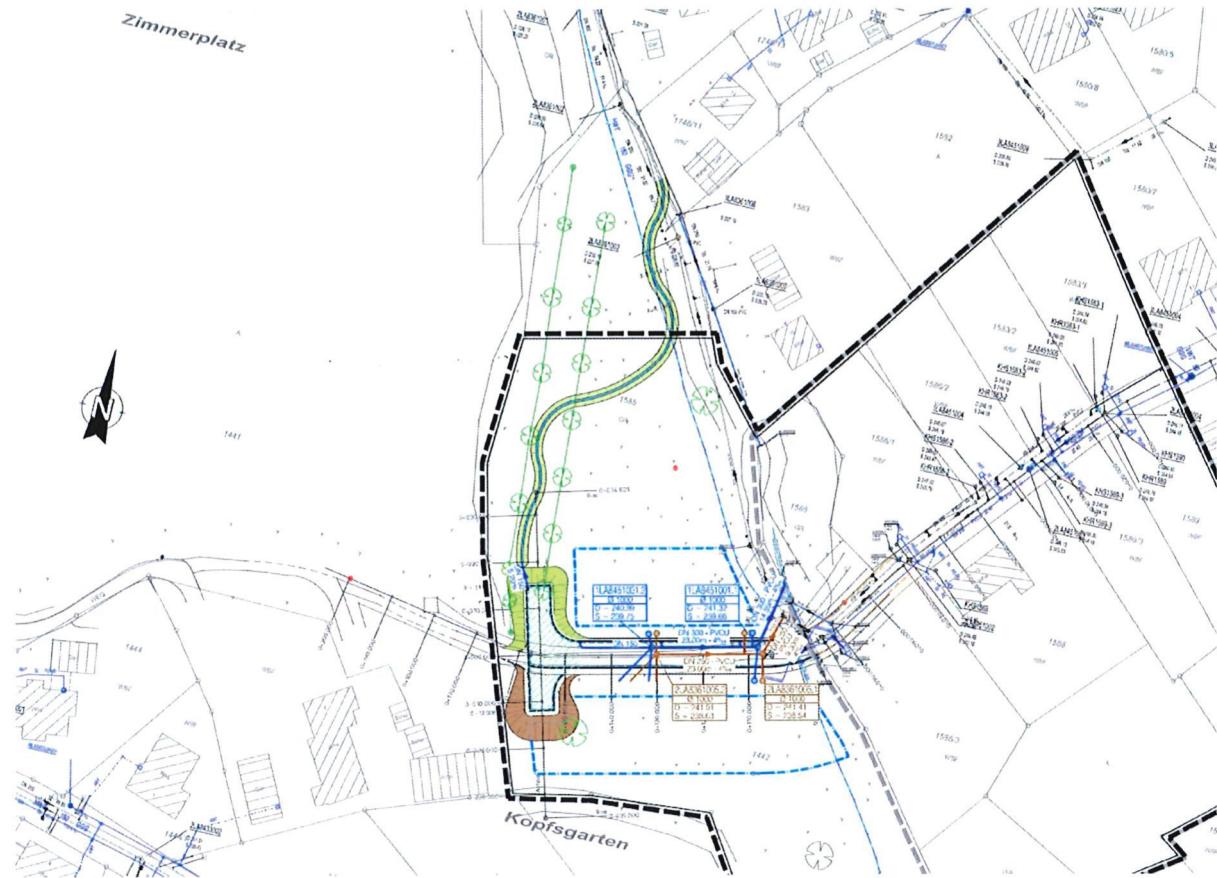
geplante Entwässerung des Plangebiets mit Darstellung der geplanten Entwässerungsmulde sowie Entwässerungsleitungen
